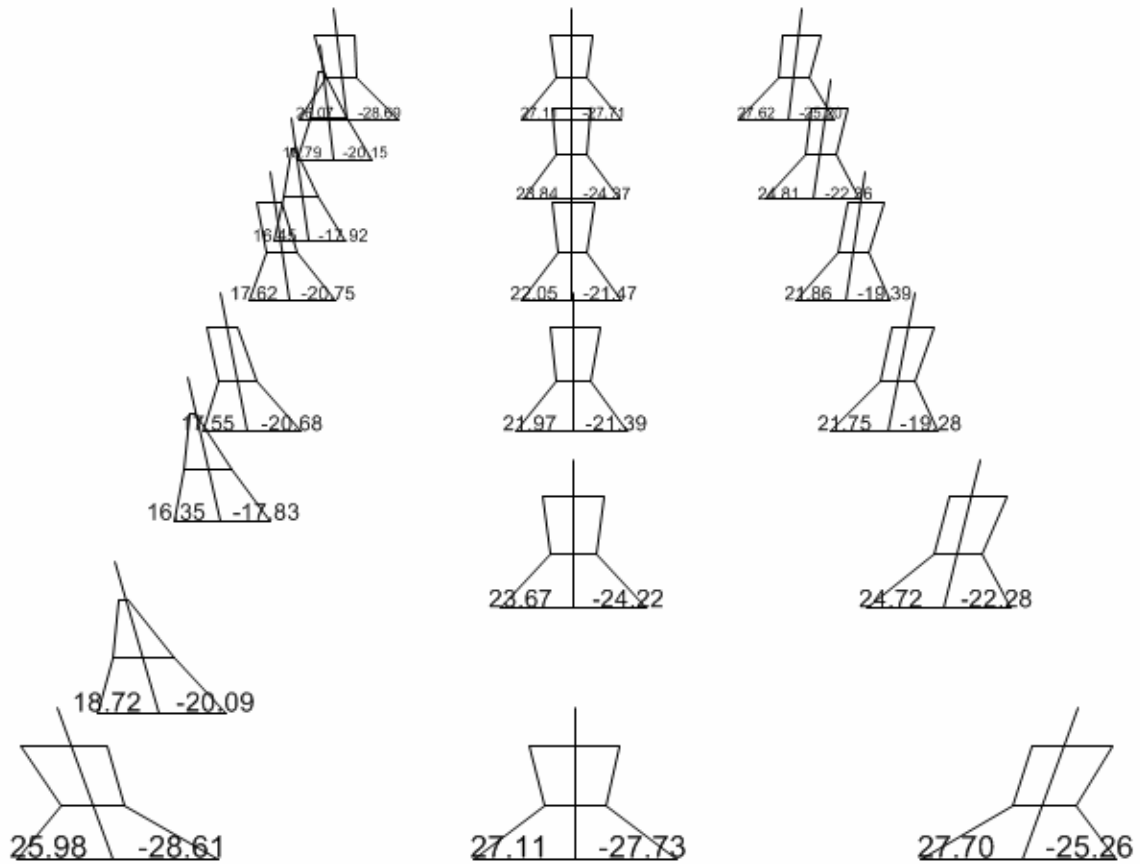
Se observan los elementos mecánicos en la planta baja. Se puede observar que las columnas toman todo el momento en la dirección corta, también se puede notar que los elementos mas alejados de la parte central de la planta son los mas solicitados.
